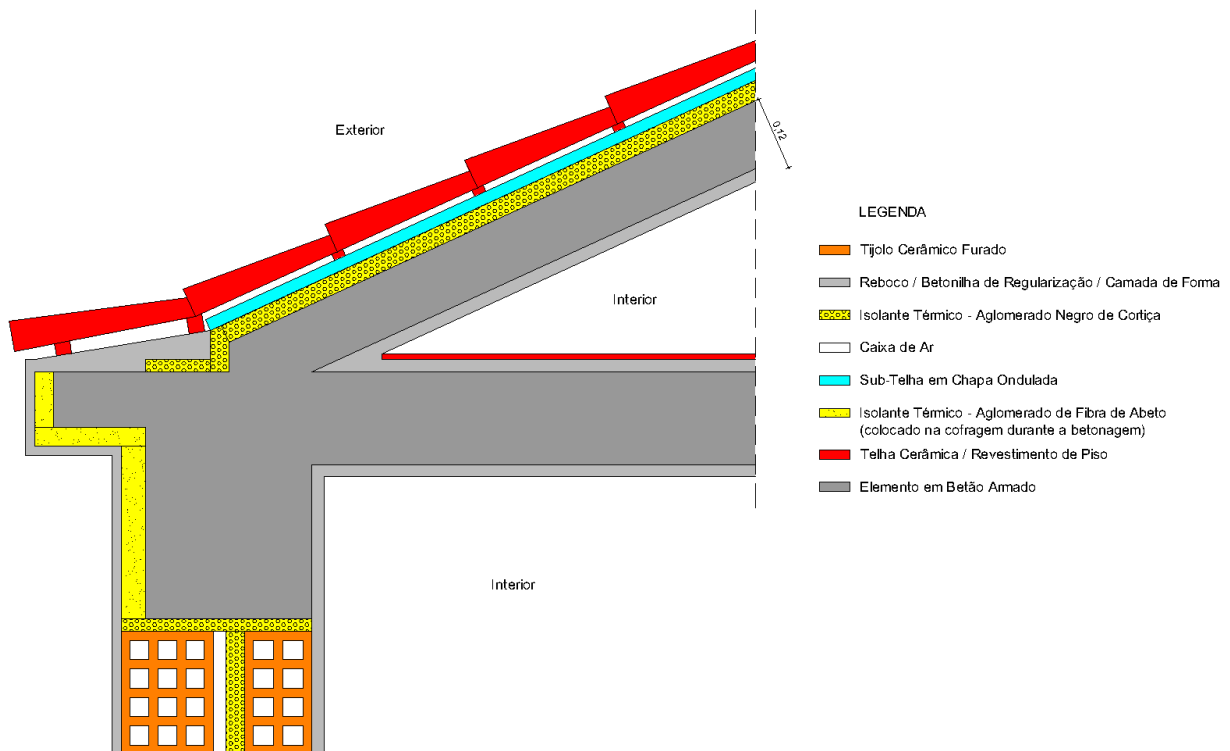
Ligação da fachada com cobertura inclinada em estrutura monolítica, adaptado de [10]
